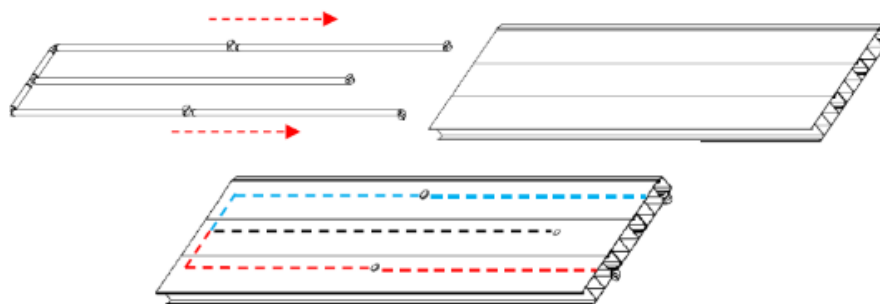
Ilustração da montagem das instalações hidráulicas em bancada, antes da montagem das paredes. (Sem escala).
